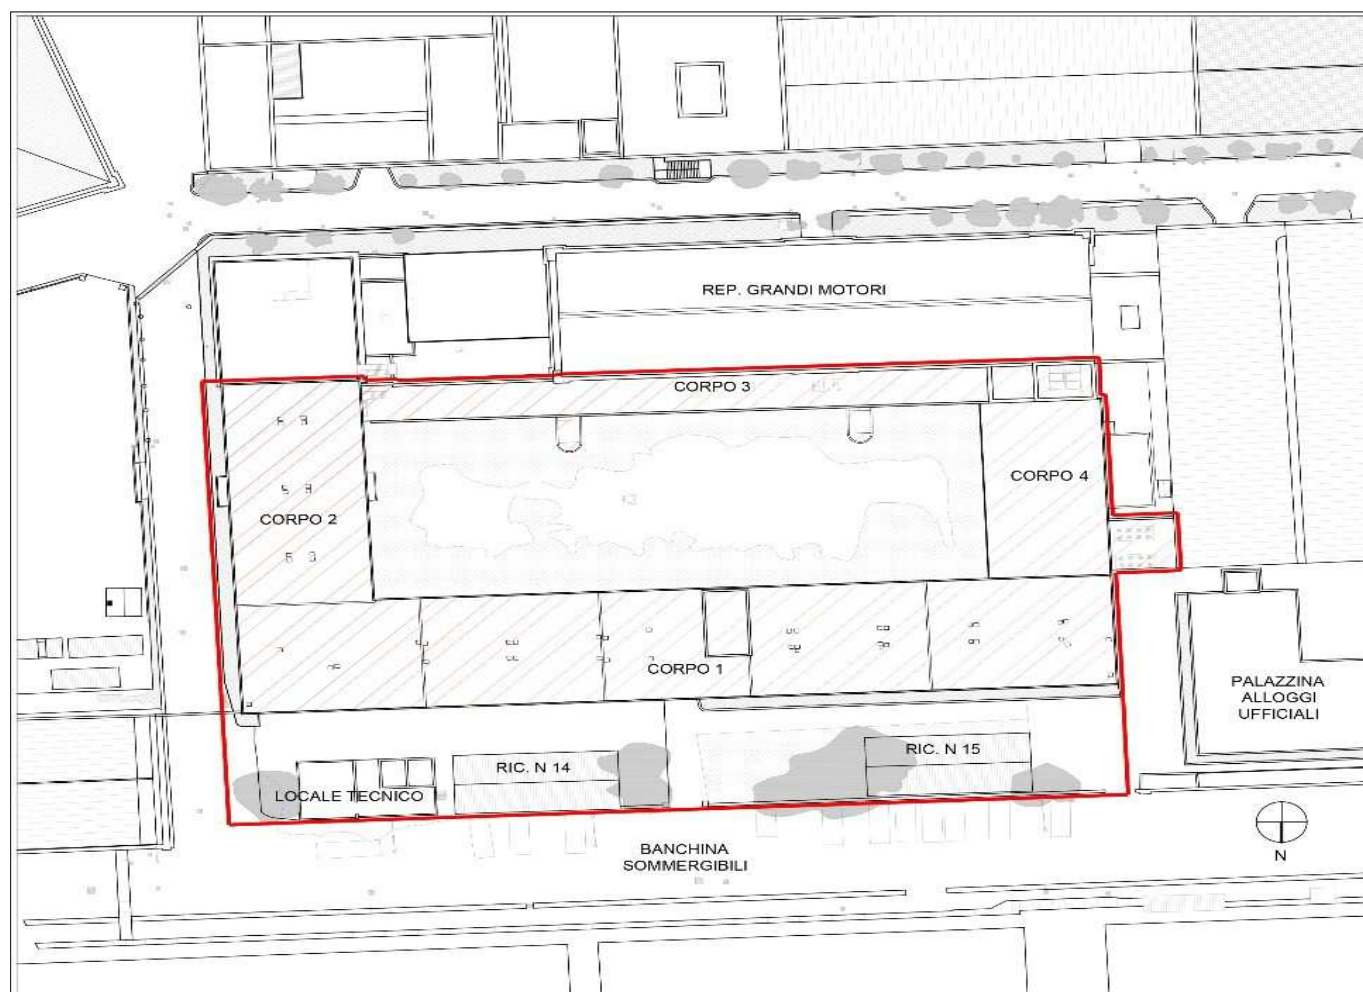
PLANIMETRIA GENERALE DELLO STATO DI FATTO ATTUALE
